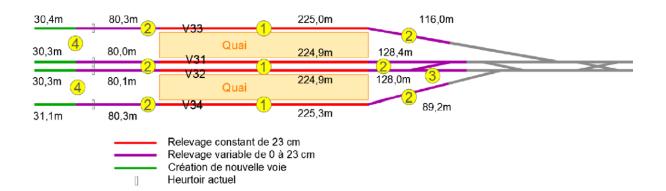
Schéma de relevage des voies – Gare Haussmann Saint-Lazare (5)
